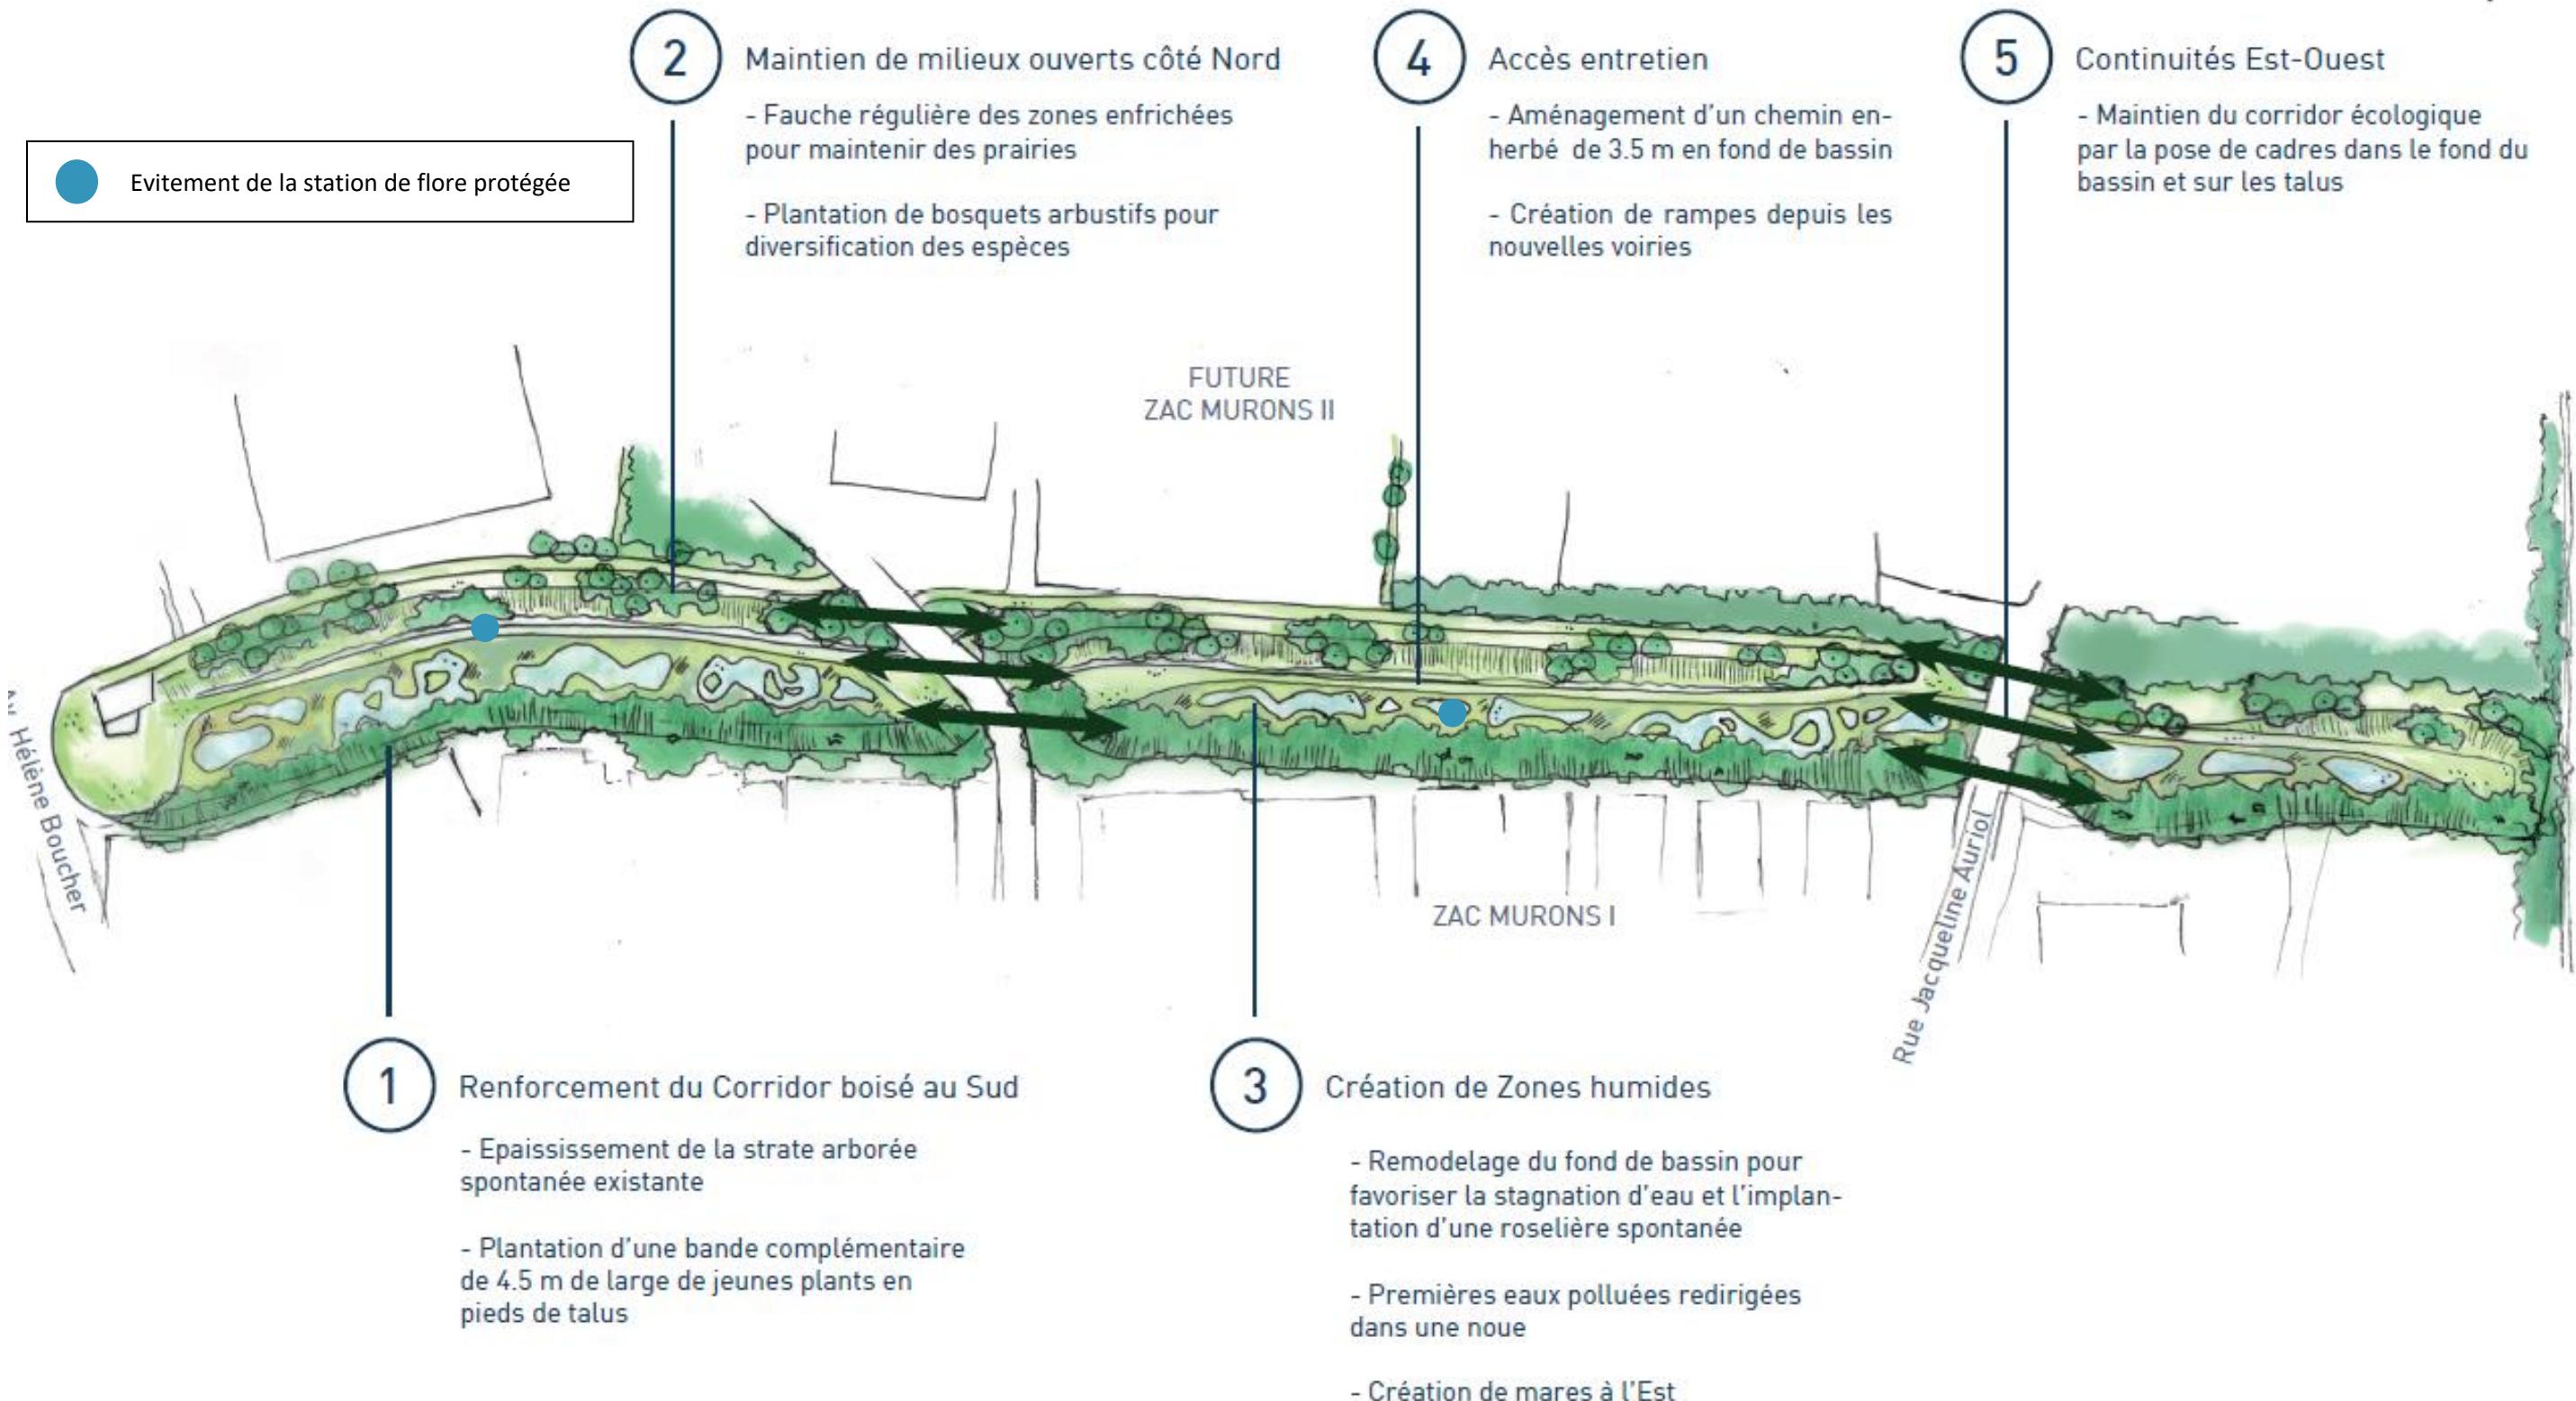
Extrait du plan d'aménagement (Graphyte, 2024)
